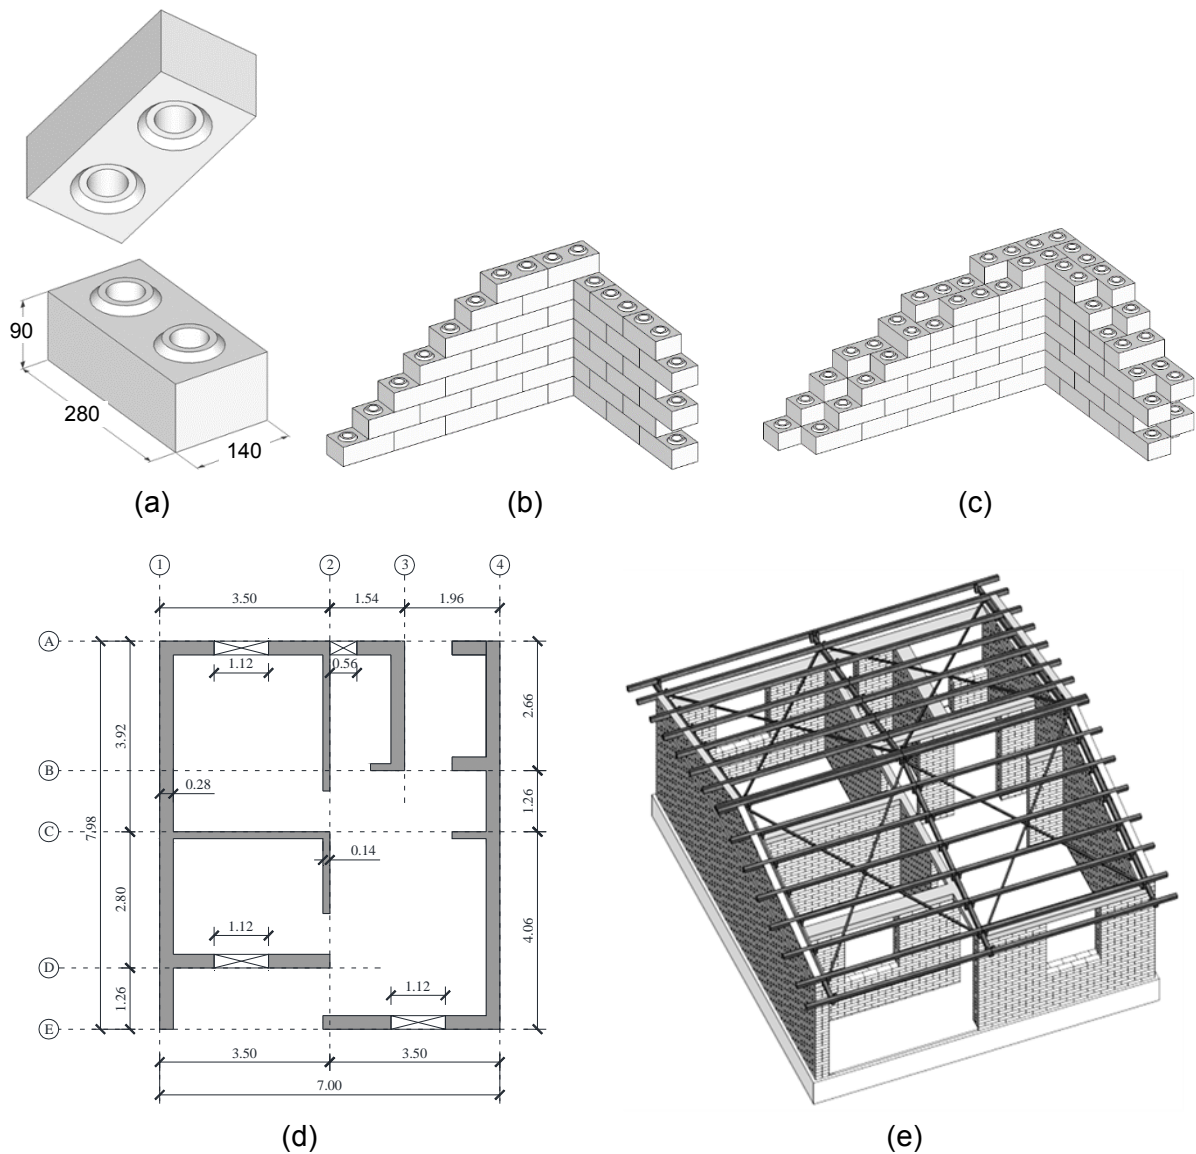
Bloco de terra compactada: (a) dimensões do bloco em mm; (b) pano simples; (c) pano duplo; (d) planta estrutural; (e) perspetiva do sistema estrutural.
